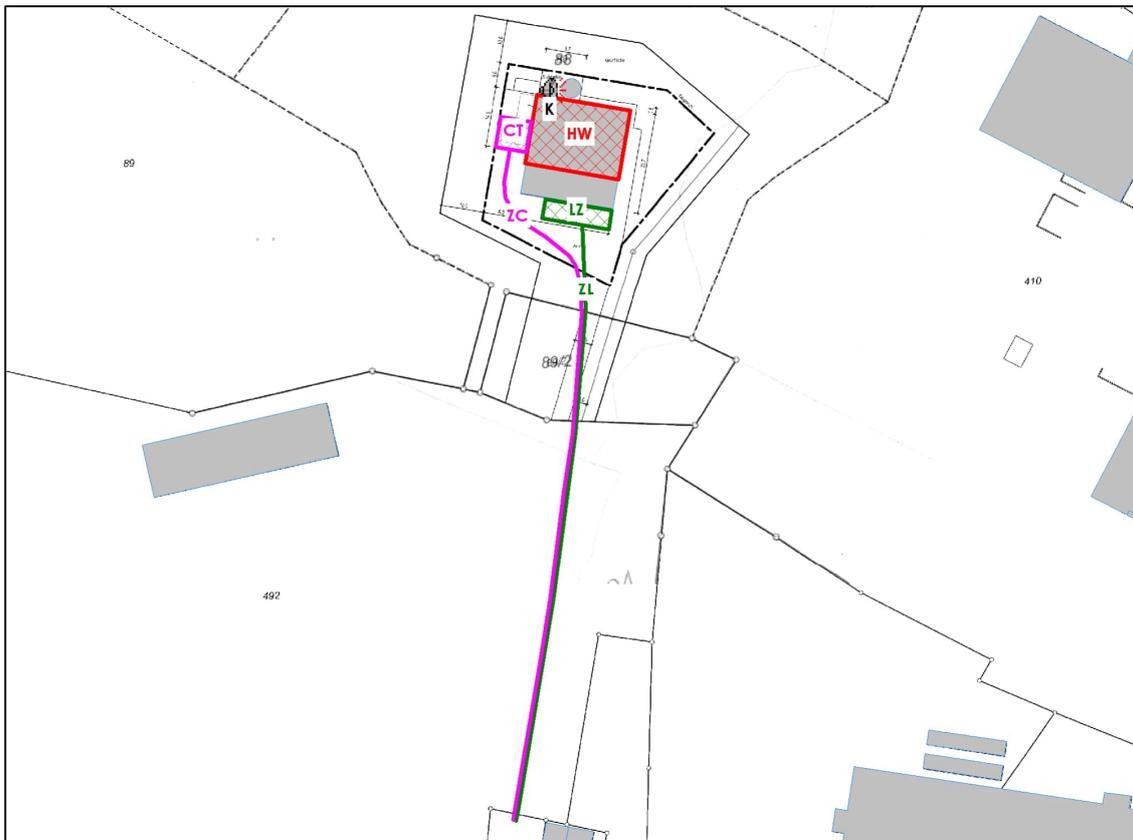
Lageplan mit Darstellung der relevanten Schallquellen des Heizwerks
